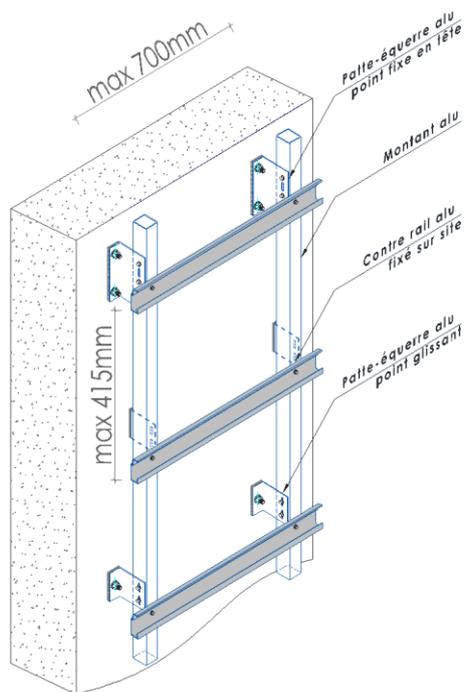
Panneau SP CERAM LAMINAM en rez-de-chaussée (Q4)
